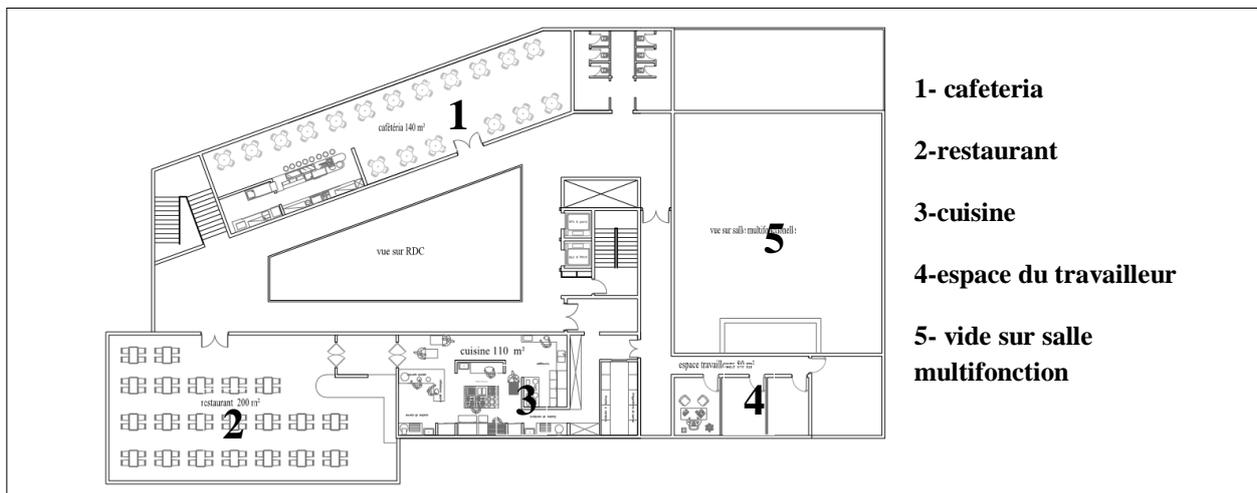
plan 1^{er} étage, (Source : auteur 2018)
